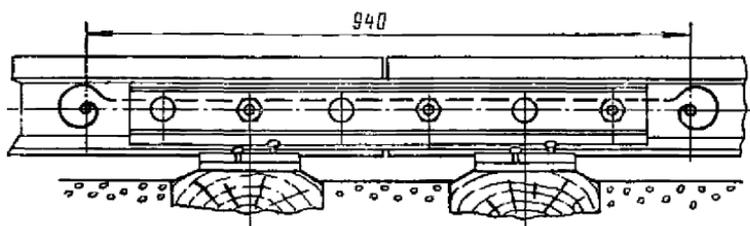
Постановка стыкового проволочного соединителя при двухголовых накладках
